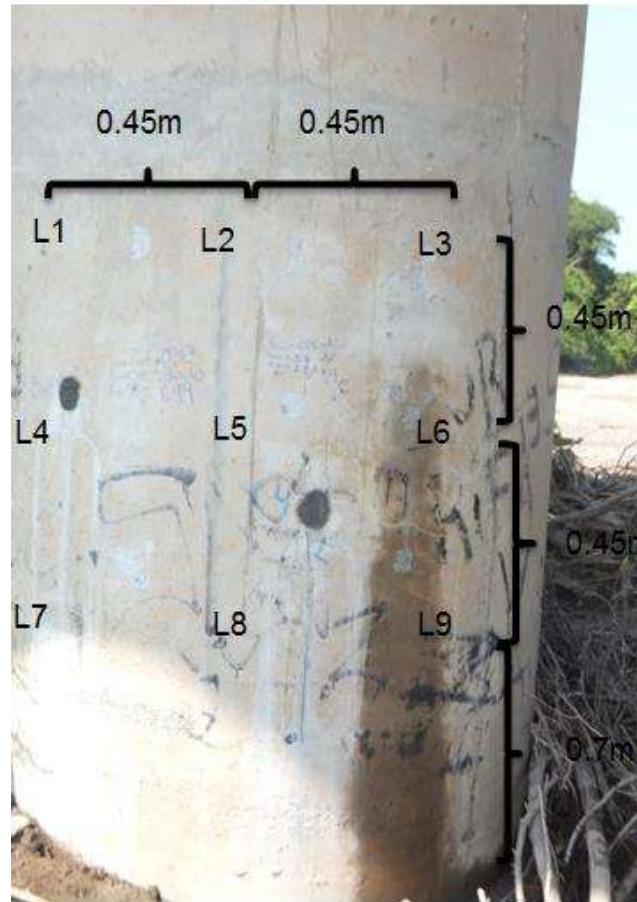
Ubicación de las pruebas con el Gecor en Pila 4
